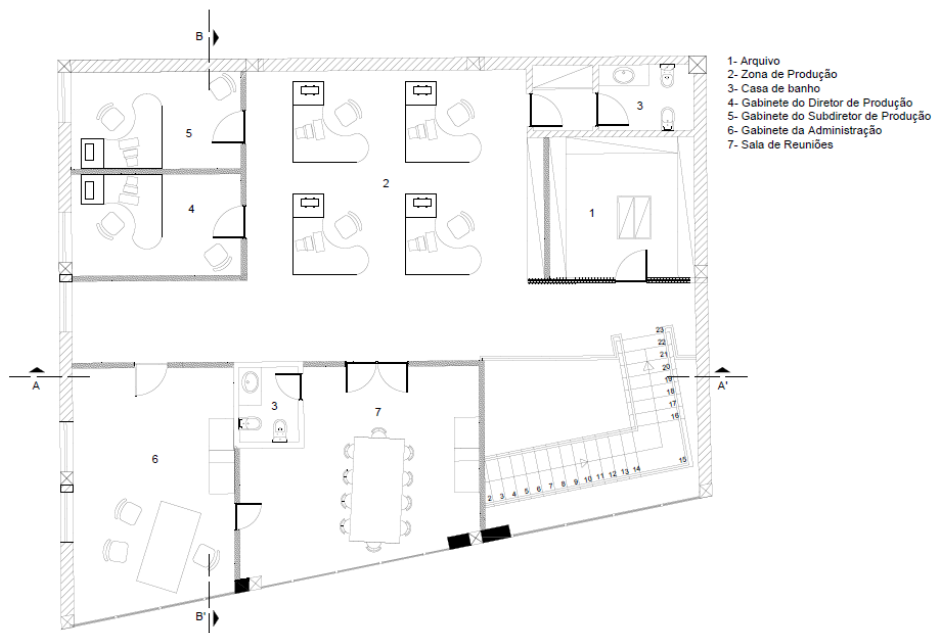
Planta de piso 1 existente, em Autocad. Fonte: Agrocinco.
